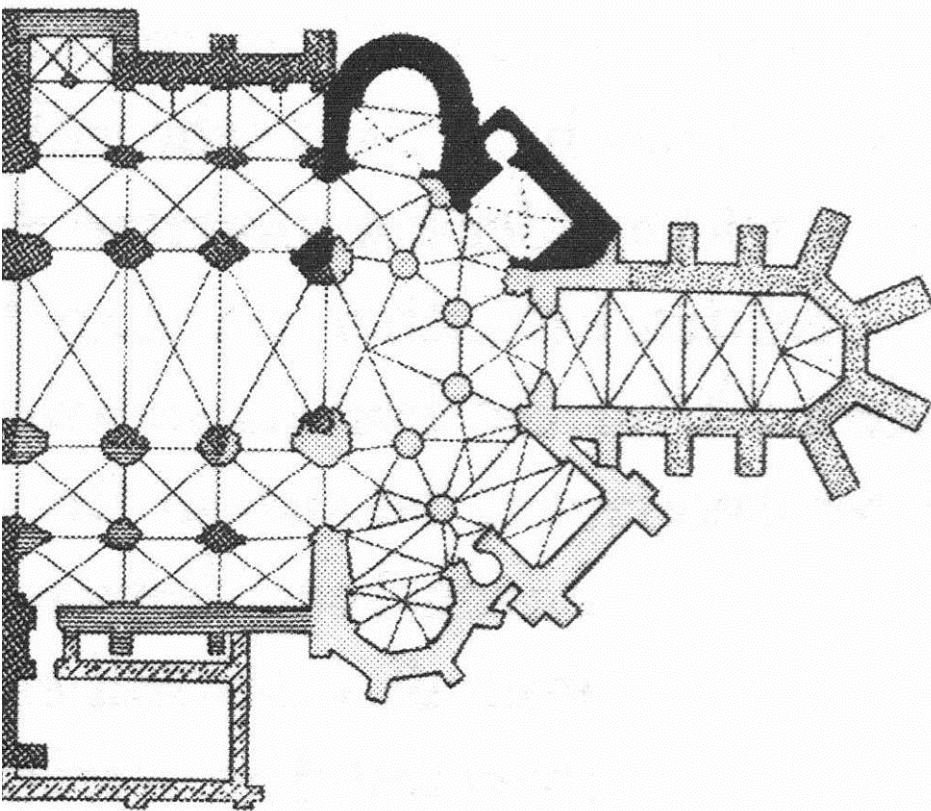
Fécamp, La Trinité, Grundriss (nach Valléry-Radot)
